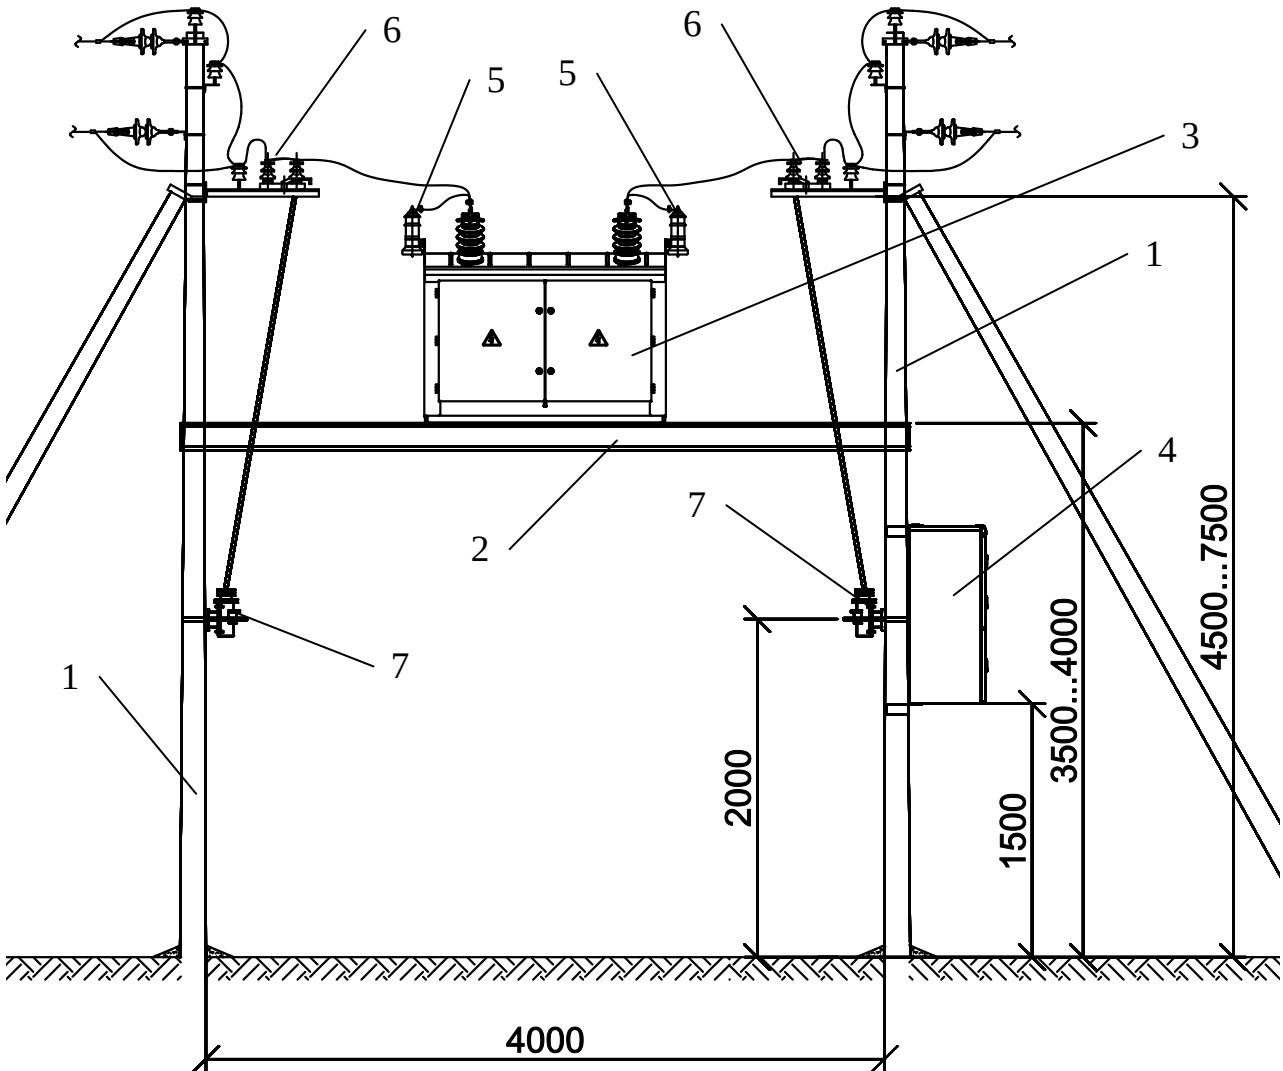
Установка ПСК/ТЭК. 1 – опора ЛЭП; 2 – рама; 3 – высоковольтный блок ПСК/ТЭК; 4 – шкаф управления; 5 – разрядники; 6 – разъединители; 7 – приводы разъединителей.
